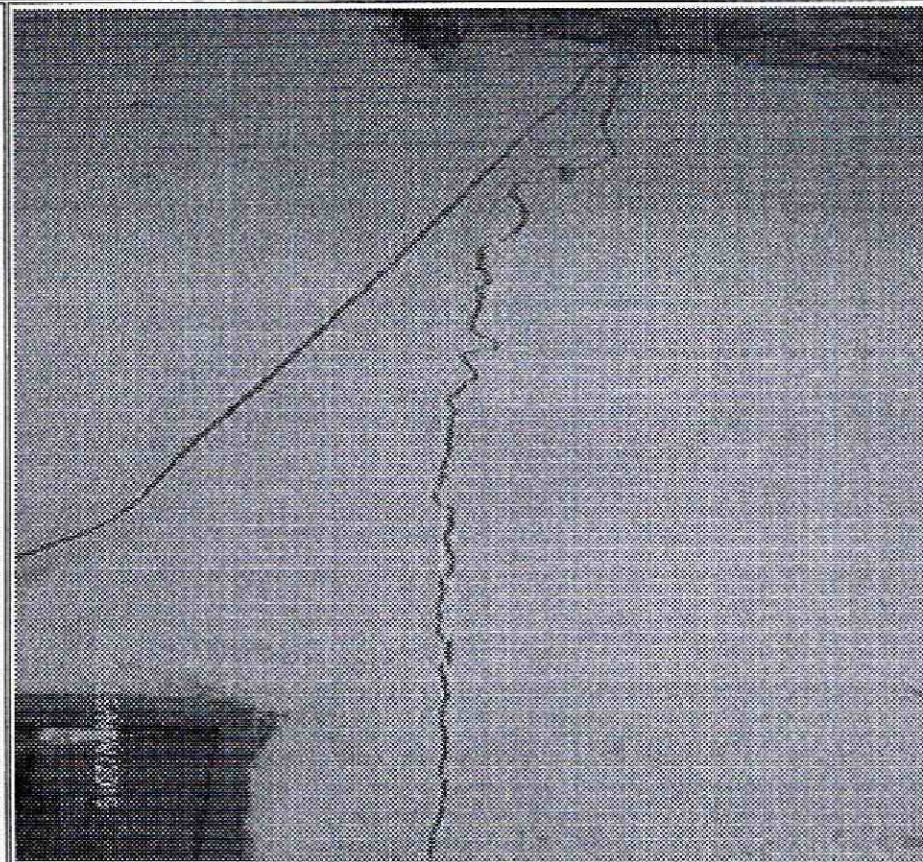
Grieta tendencia vertical muro divisorio primer nivel de la vivienda
